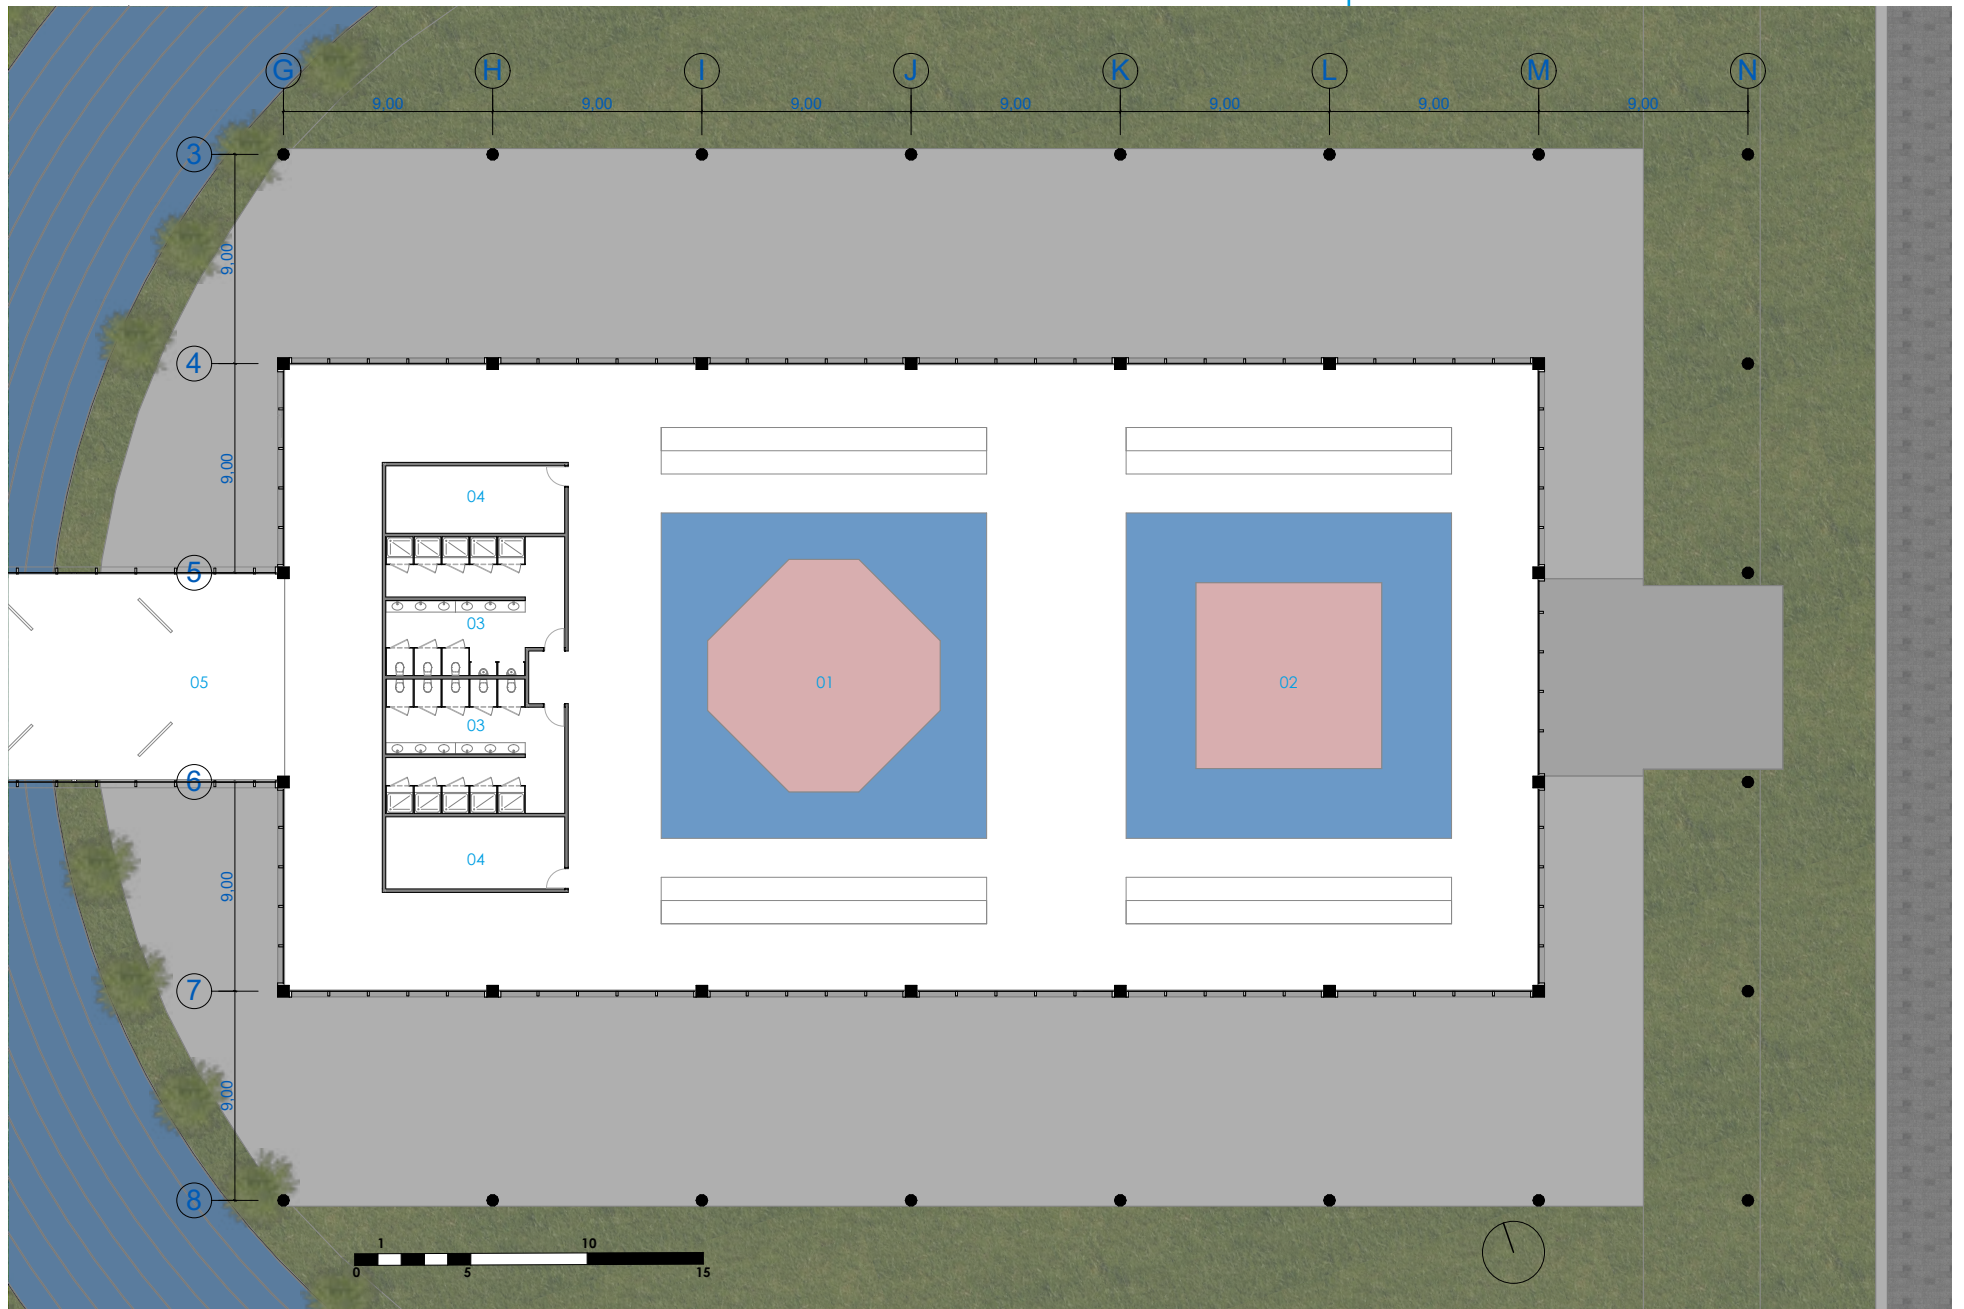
Planta alta n. +10,00 m, bloque A, proyecto arquitectónico. Elaboración: Propia.
